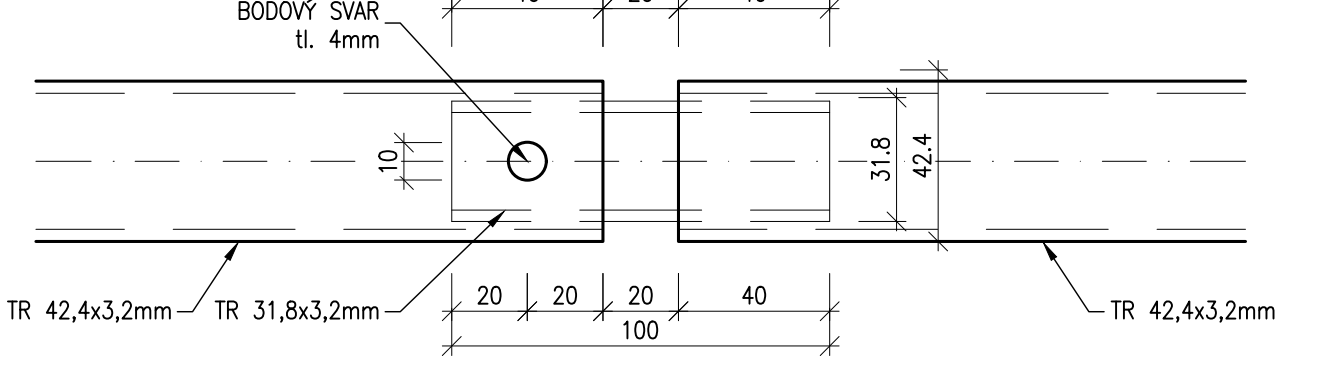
DETAIL B – UKONČENÍ DOLNÍHO MADLA
